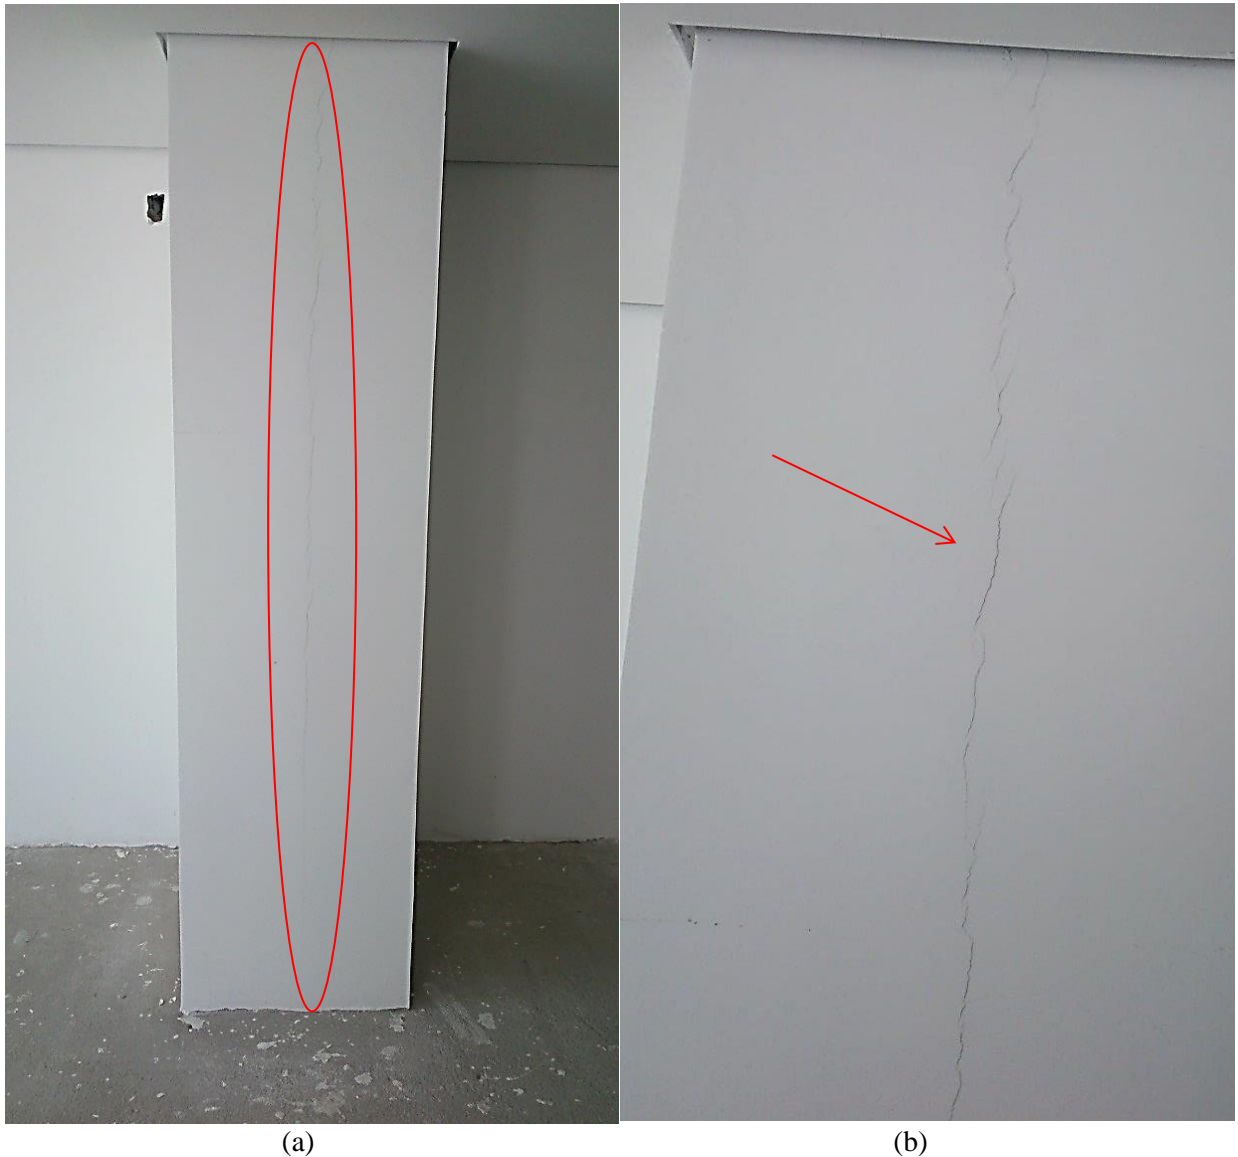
Fissura longitudinal próximo à esquadria metálica
